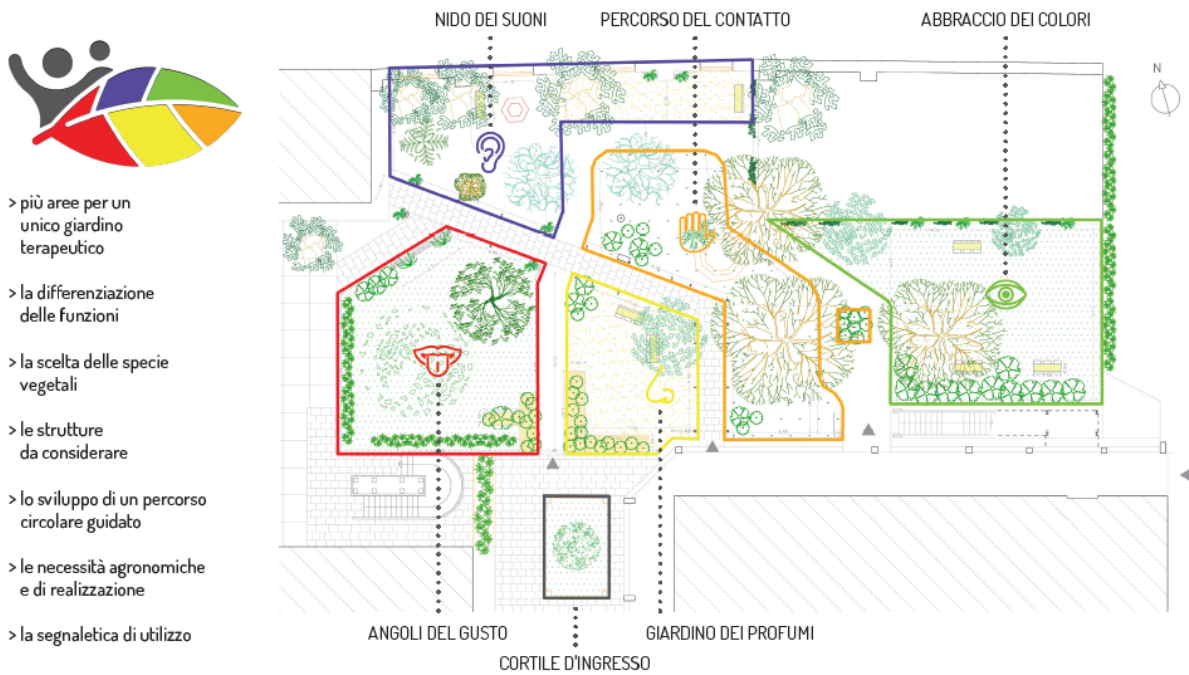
IL PROGETTO, planimetria generale e zonizzazione rispetto al concept | (Tavola 5 – Progetto Daniele Conte architetto paesaggista | Progetto di healing garden per l’Ospedale Fatebenefratelli di Venezia – 2017)
